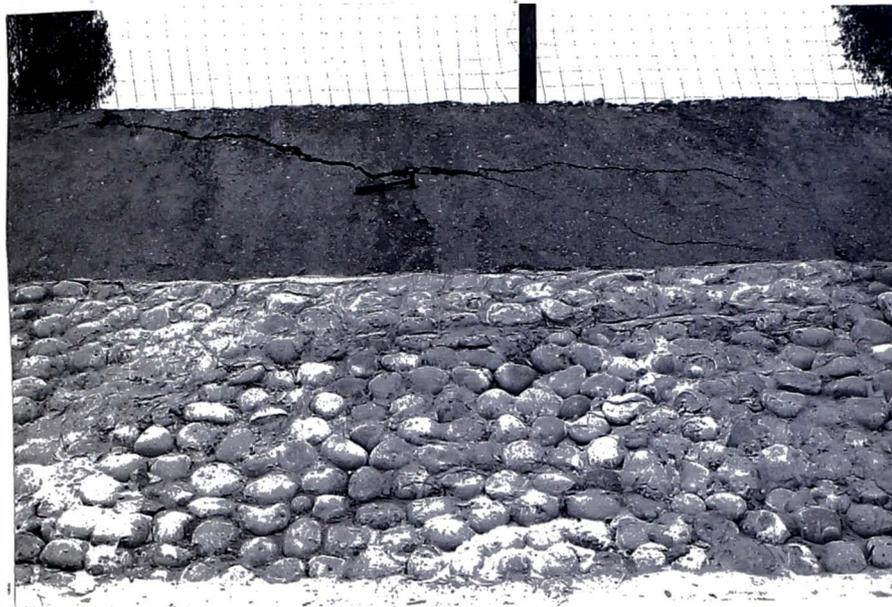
Vistas desde el interior de la planta de tratamiento de desague apreciándose grietas de desecación en el terra-plén y fracturas en el empedrado.
